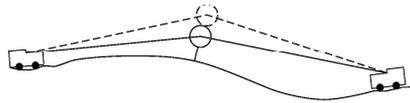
鏡面の設置高さを低くした例⁹⁾
